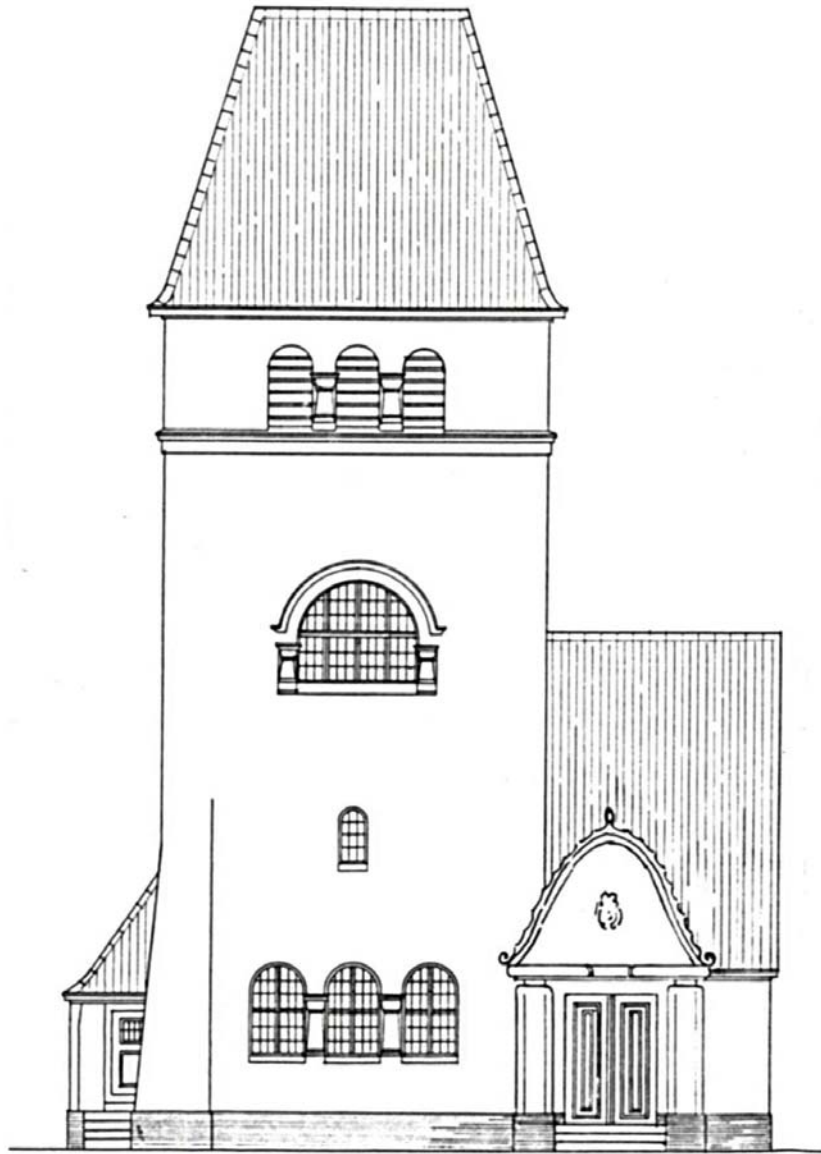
Außenansicht, Eingangsfassade, Entwurf Walter Böhm, September 1913
